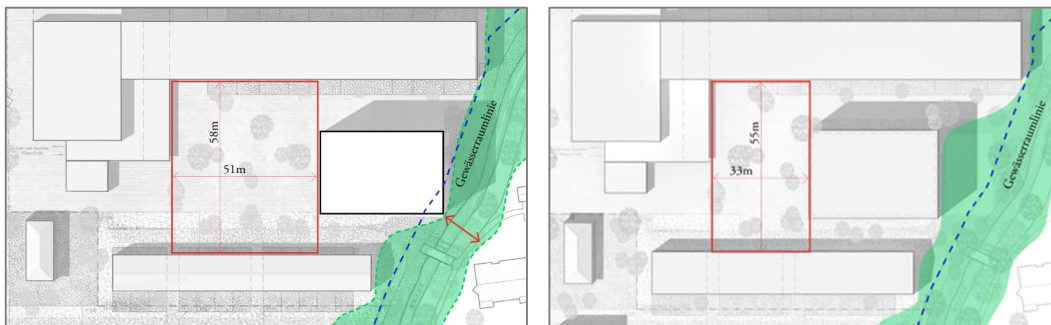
Vergleich Bebauungskonzept mit Erhaltung Lagerturm (links) und Ersatzbau (rechts)
